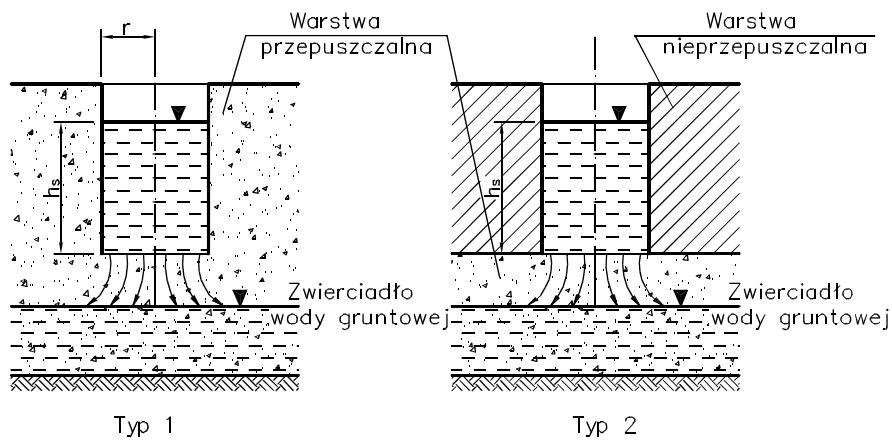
Konstrukcja gruntowej studni chłonnej [12]
